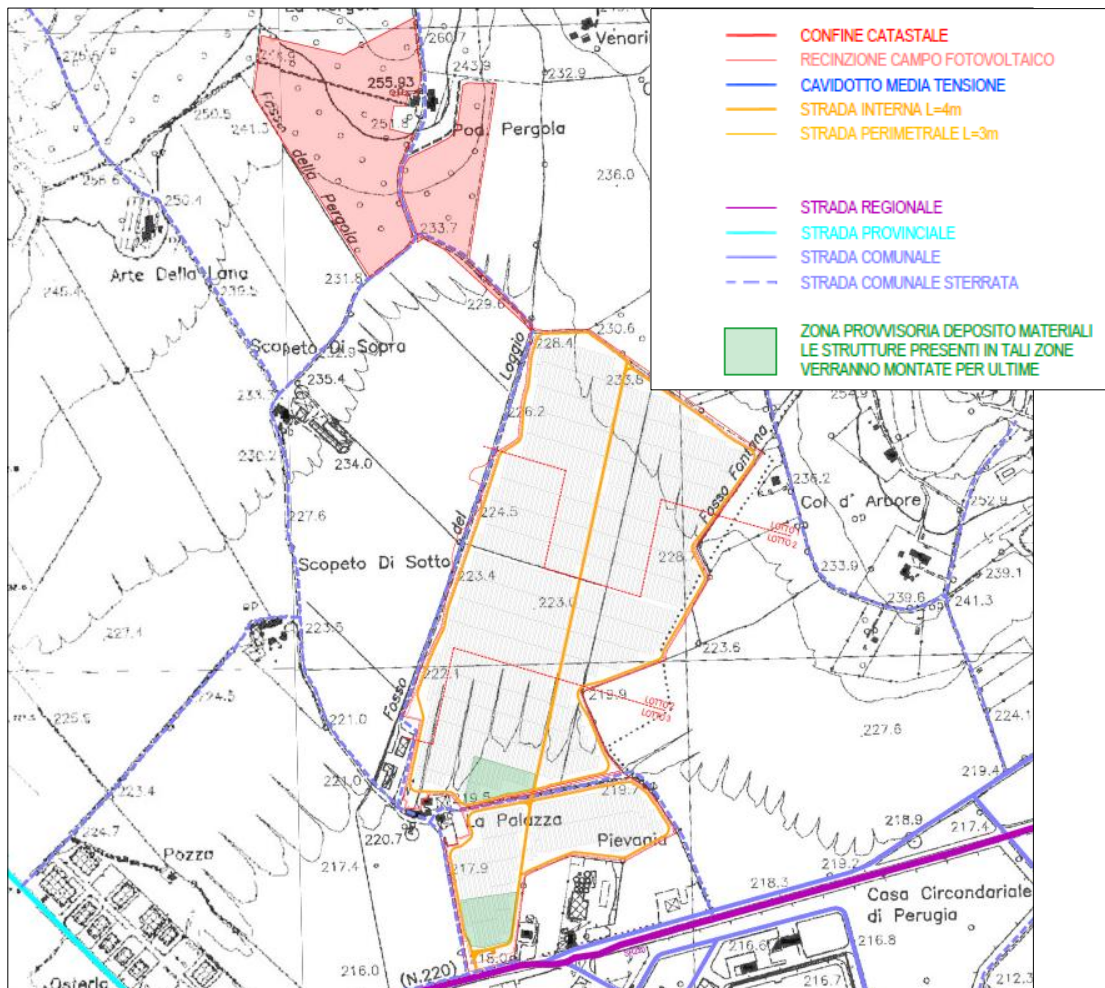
Ubicazione aree di cantiere dell'impianto
